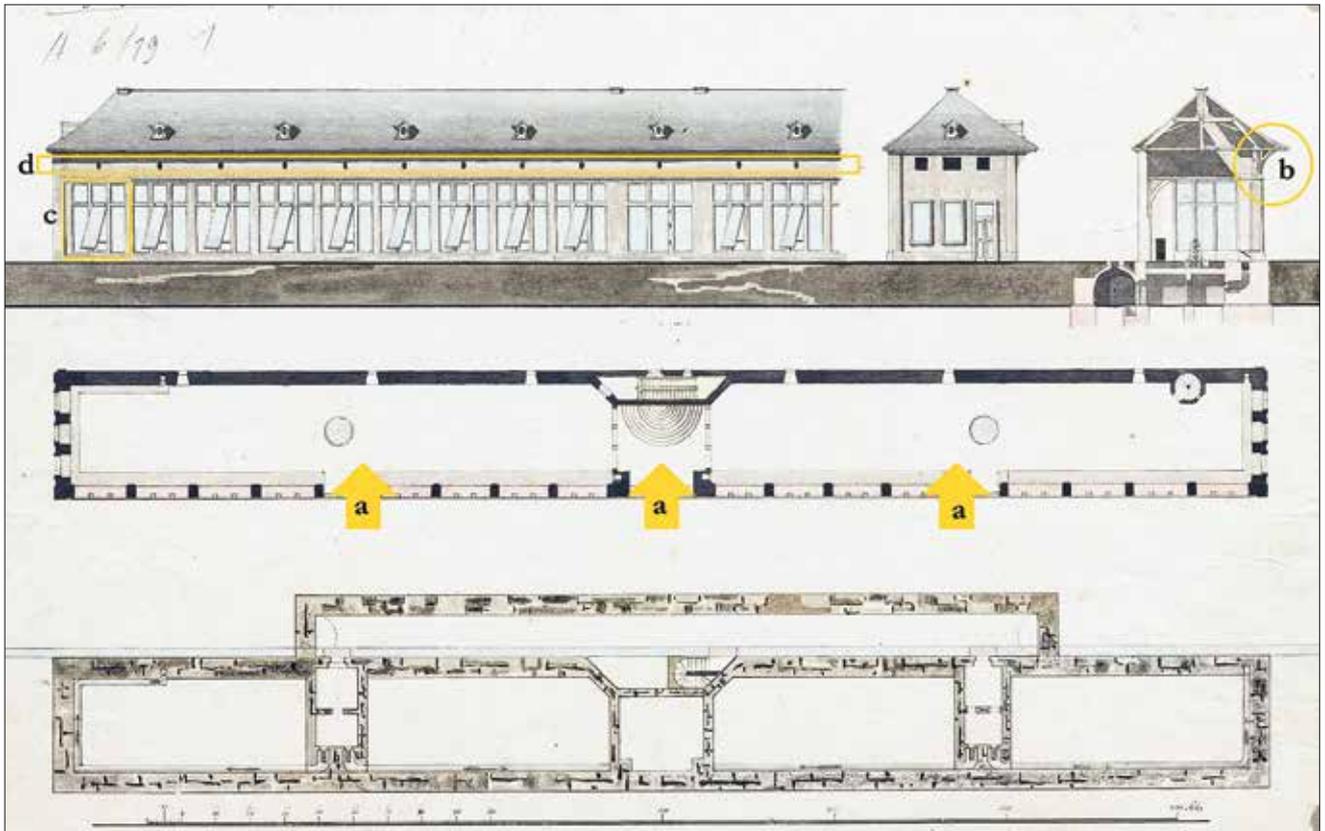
Orangerie, Bauaufnahme 1825, Erläuterung Zustand vor 1945 (Planzeichnung 1825 mit Ergänzungen 2021, Sebastian Väh, BSV, Plansammlung Gärtenabteilung: WÜ-02-05-28)
